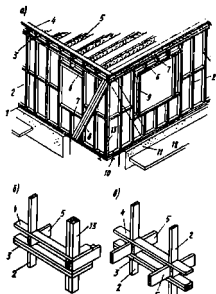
Конструкции каркасного дома с платформенным сопряжением стоек:
